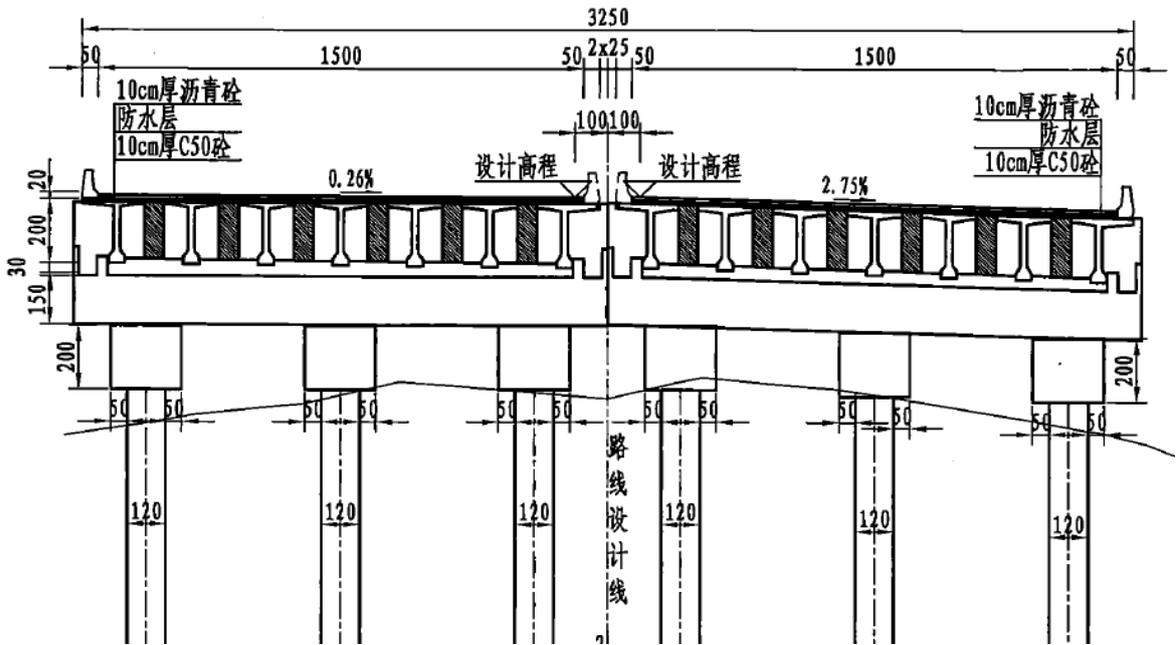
(4) 新建一般桥梁标准横断面图 (王家庄大桥)
